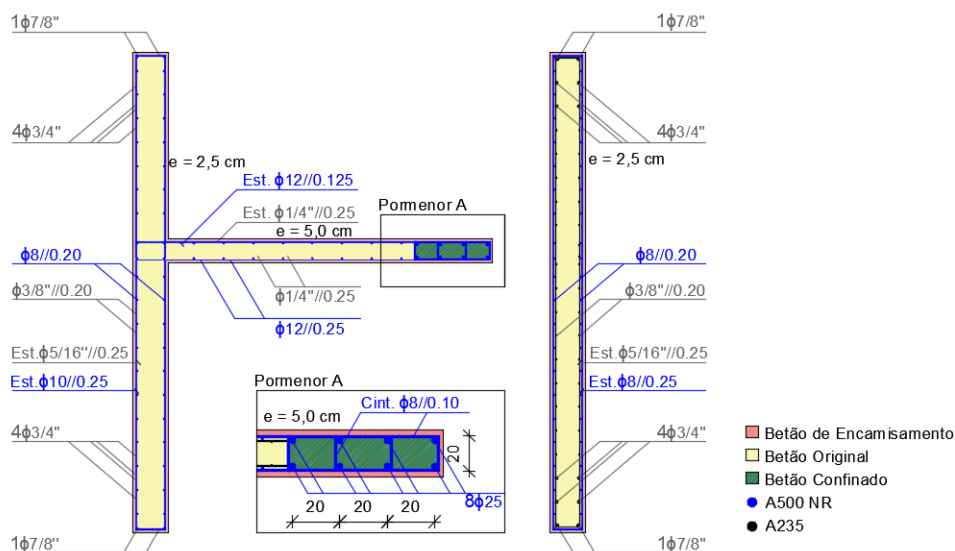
Solução de reforço das paredes com o encamisamento em betão armado.
